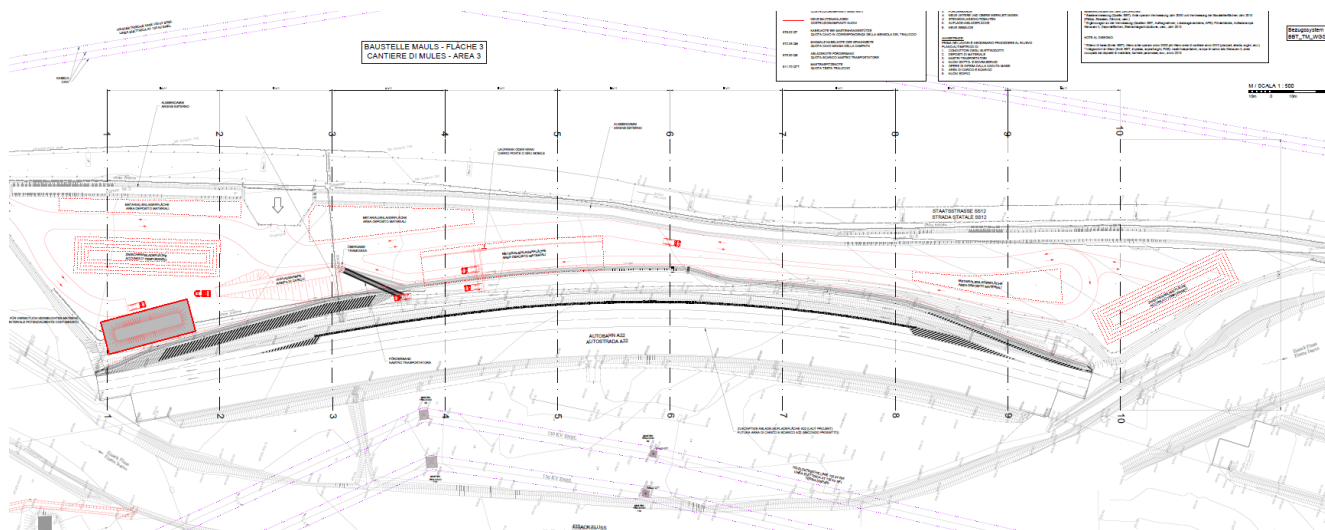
Baustelle Mauls: Lageplan Fläche Nr. 3
